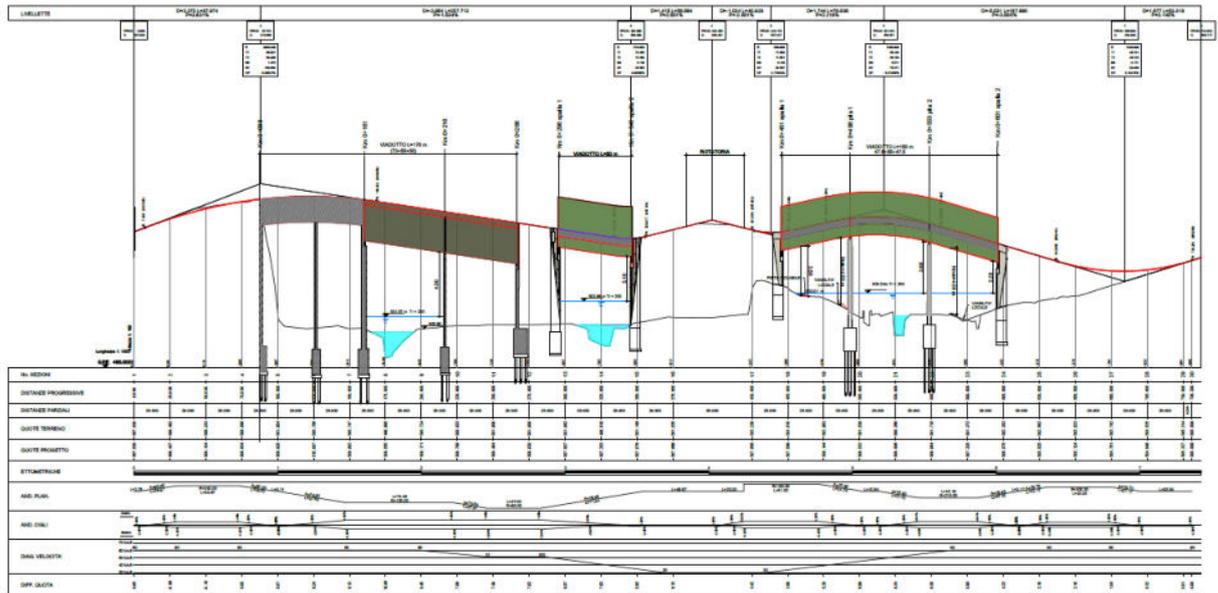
Profilo di progetto Alternativa1- variante completa
